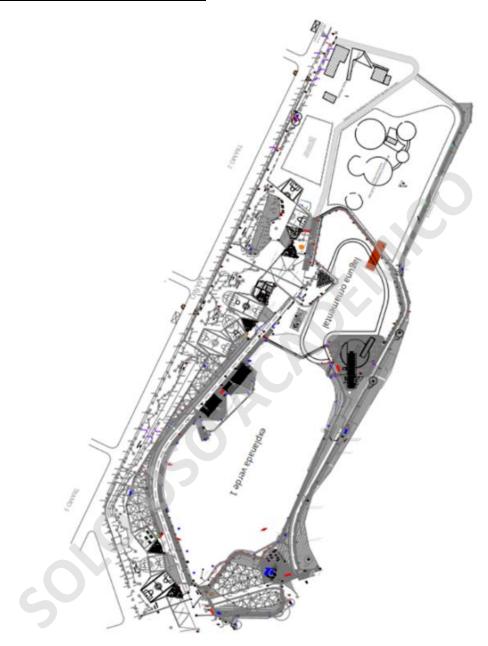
Plano inicial Parque República de Brasil vista en planta. Fuente: Ministerio de Vivienda y Urbanismo.
